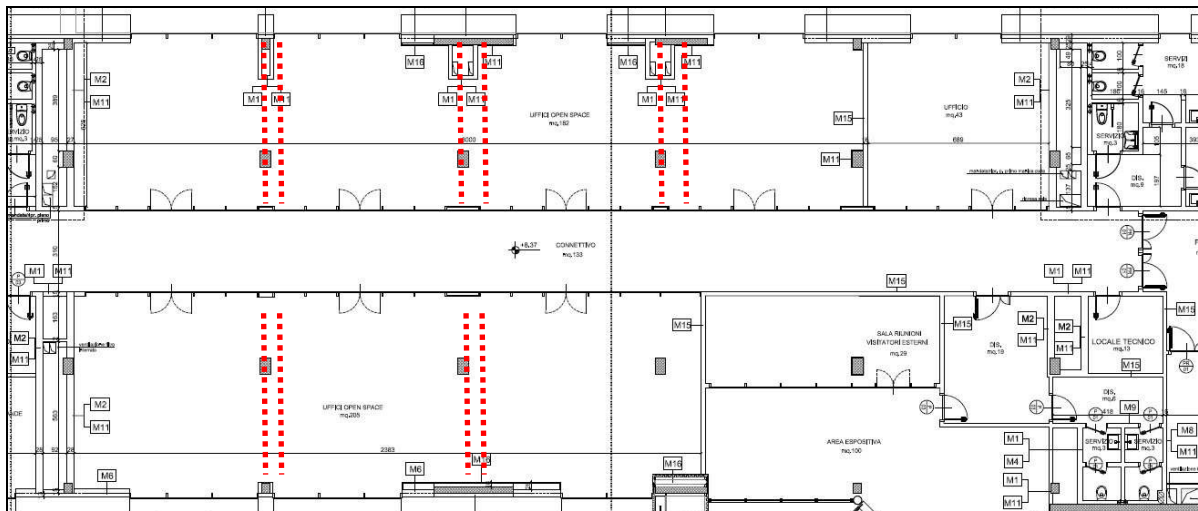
Stralcio della pianta del primo piano con indicazione, in rosso, della possibile divisione degli open space.
